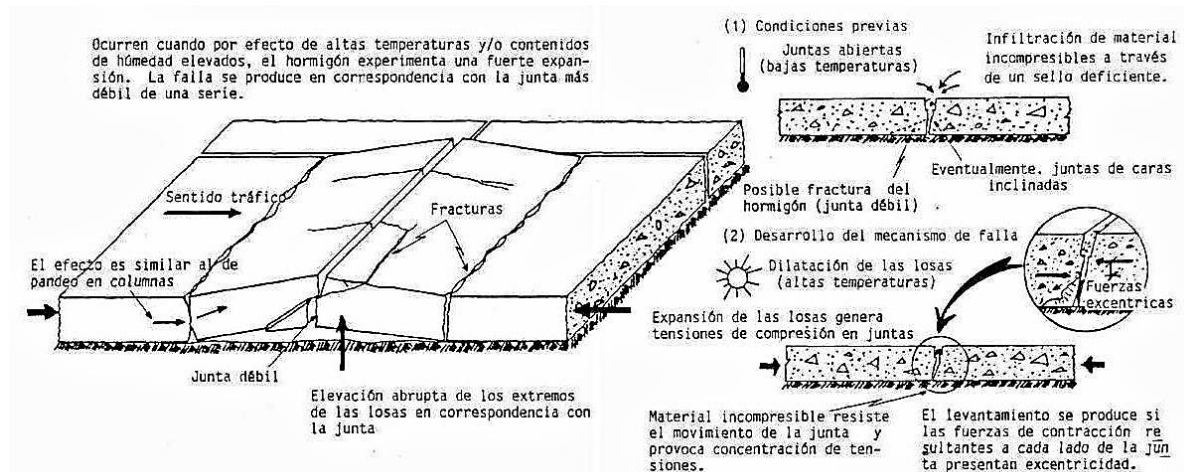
Esquema de levantamiento en pavimentos rígidos.¹⁴²
